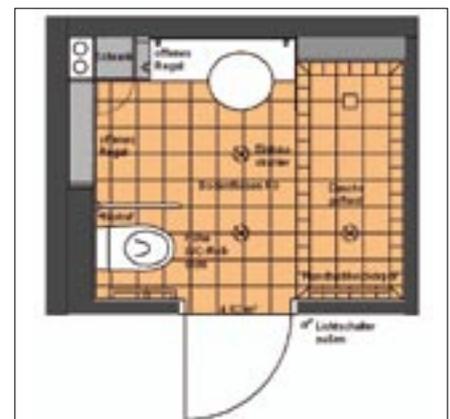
Grundriss Bad nach DIN 18025, Teil 2: Der Duschbereich hat eine Fläche von b/t = 80 cm/180 cm, damit ist auch eine Badewanne möglich [27].
